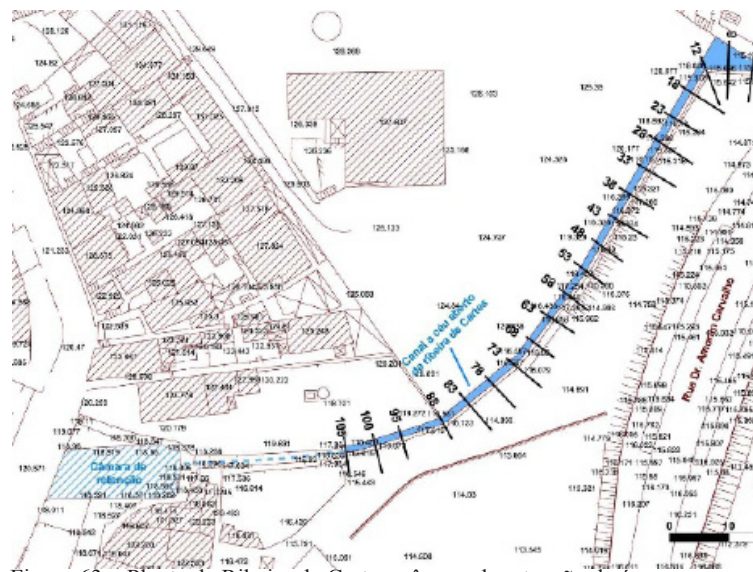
Planta da Ribeira de Cartes, câmara de retenção de água
